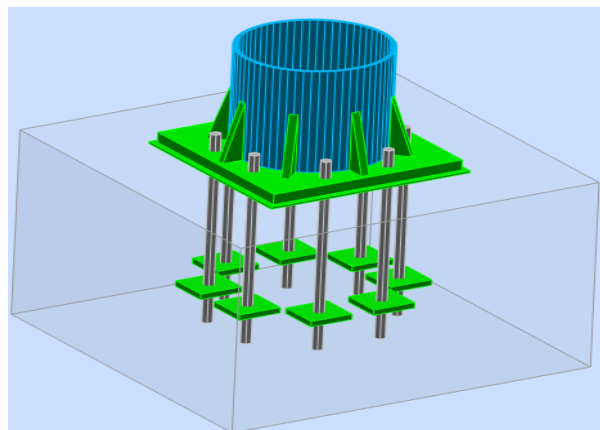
Pied de poteau avec tiges d'ancrage à tête marteau
